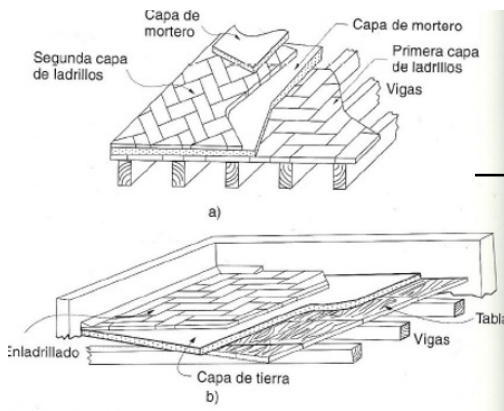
Sistema estructural de entresijos y cubiertas. (Meli, R. 1998)
